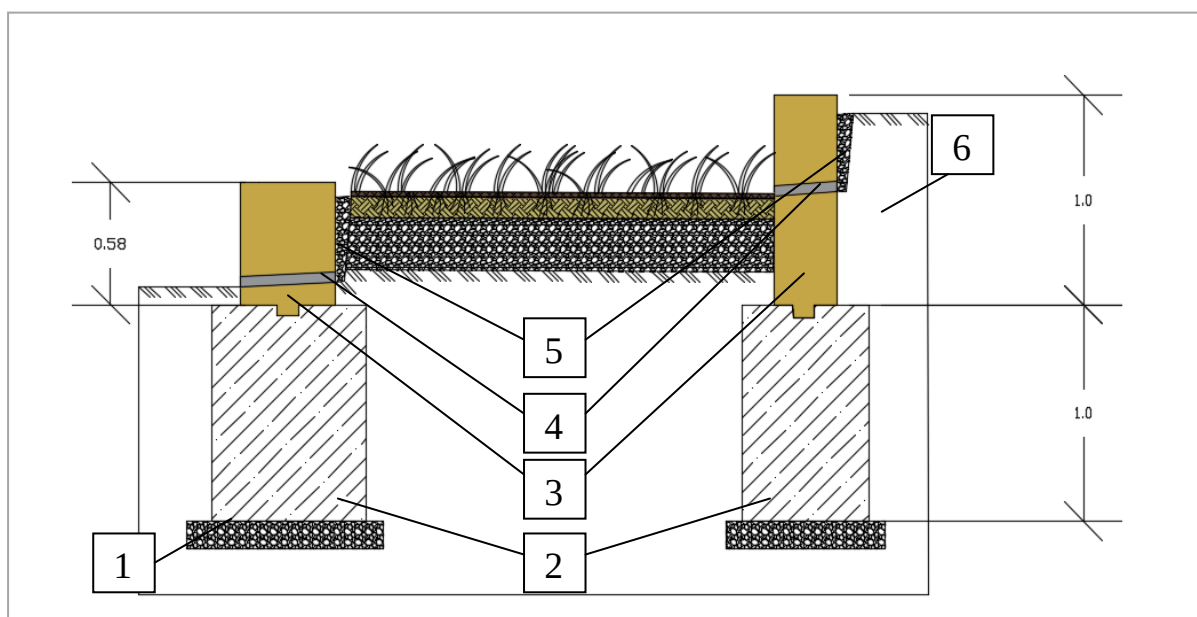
Конструкция подпорных стен: 1 – песчано-гравийная подушка, 2- фундамент, 3- тело из блоков природного камня, 4 – паз для водоотведения, 5 – дренаж, 6- грунт
